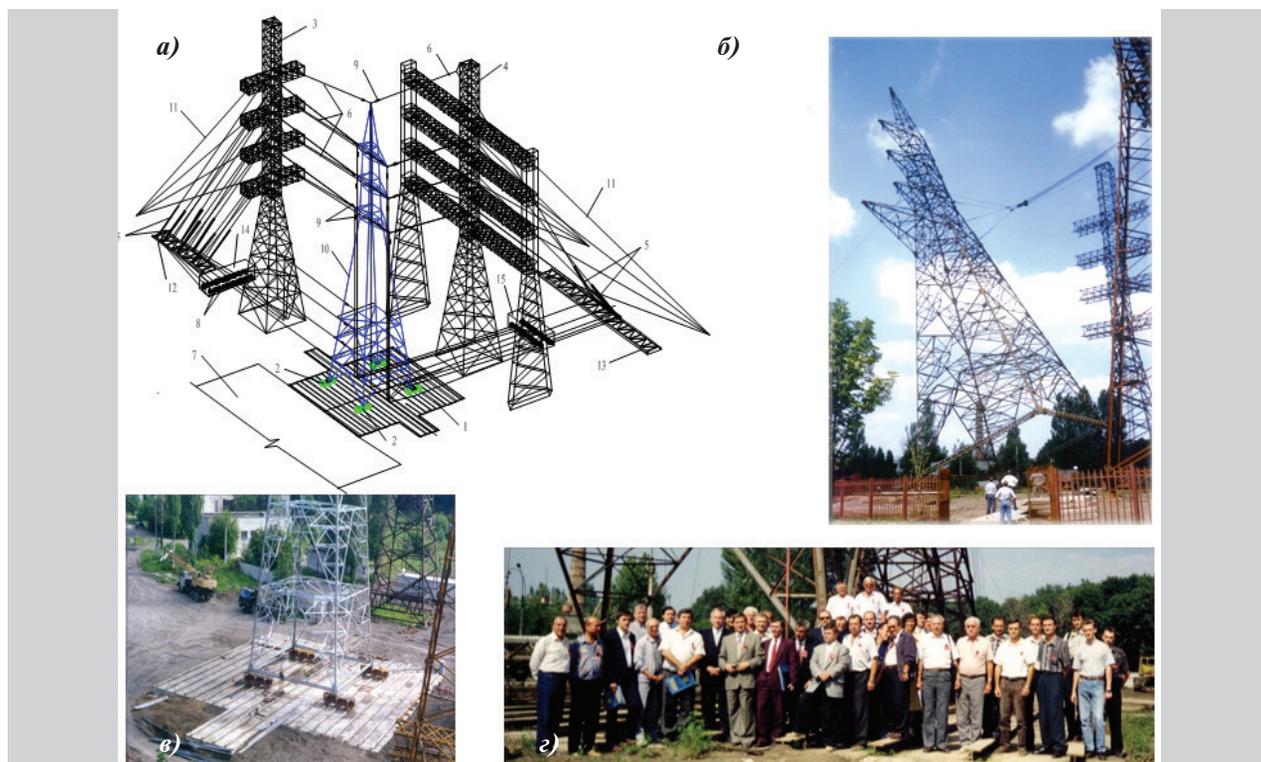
Полигон испытаний башенных сооружений и опор линий электропередачи ДОННАСА:
